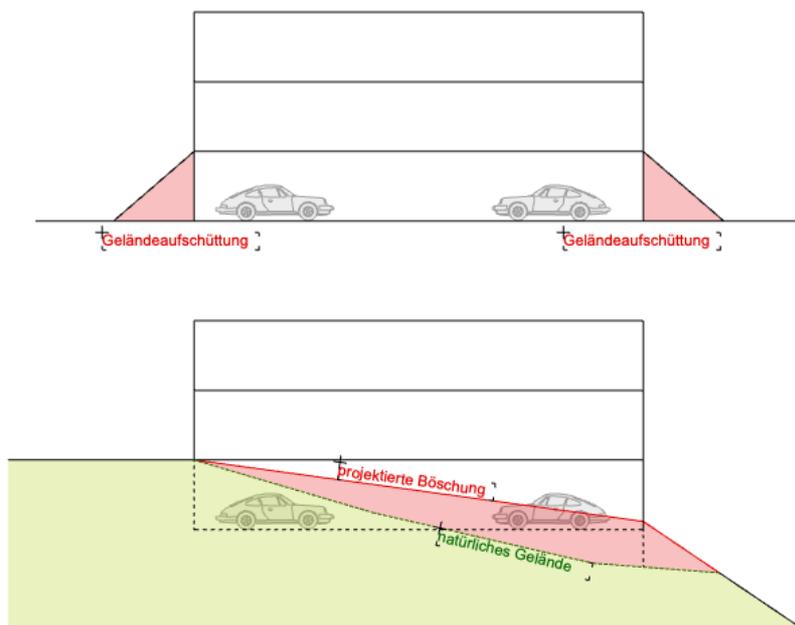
Position einer TG ebenerdig und in Hanglage. Jeweils mit projektierte Geländeänderung.
